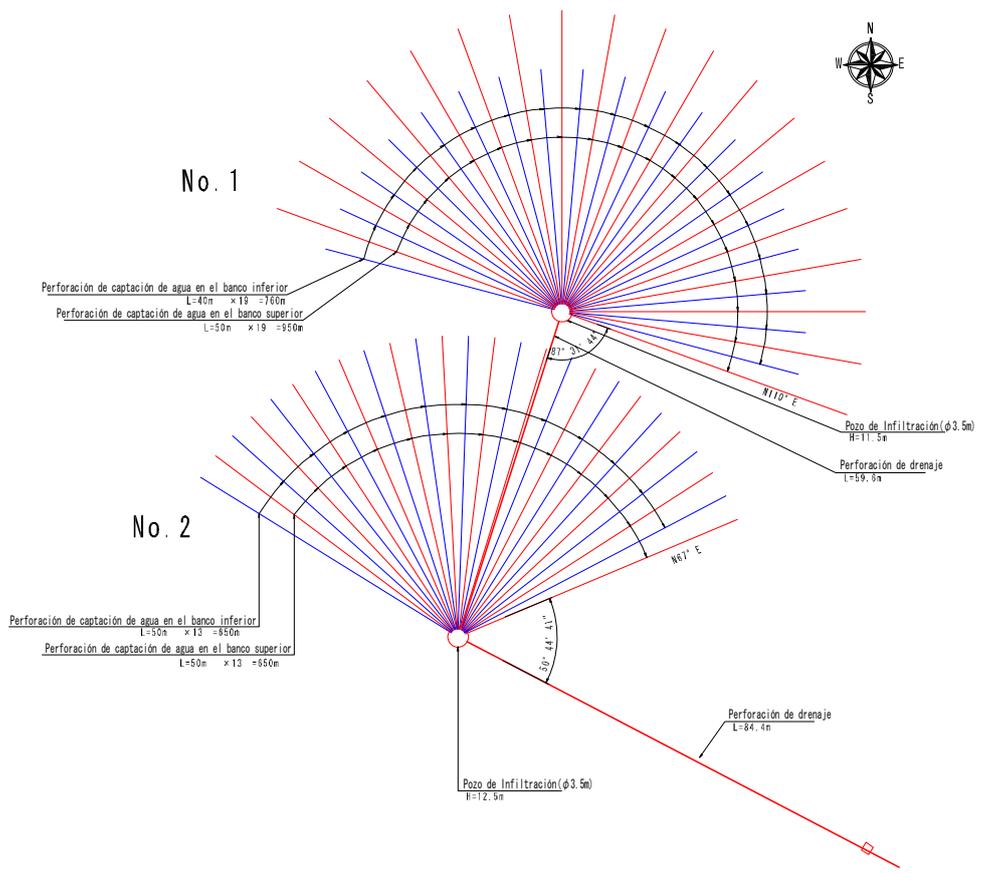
Plano de disposición plana de los pozos de infiltración (El Reparto)
